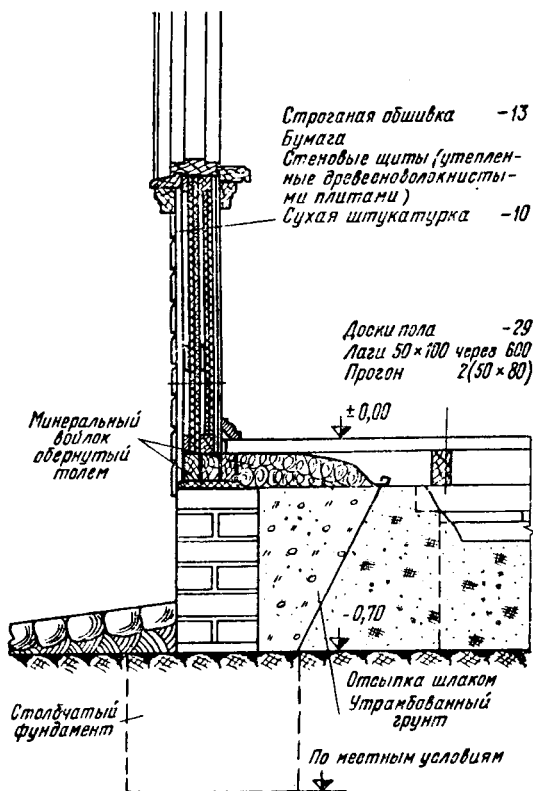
Цокольный узел одноэтажного деревянного дома щитовой конструкции
